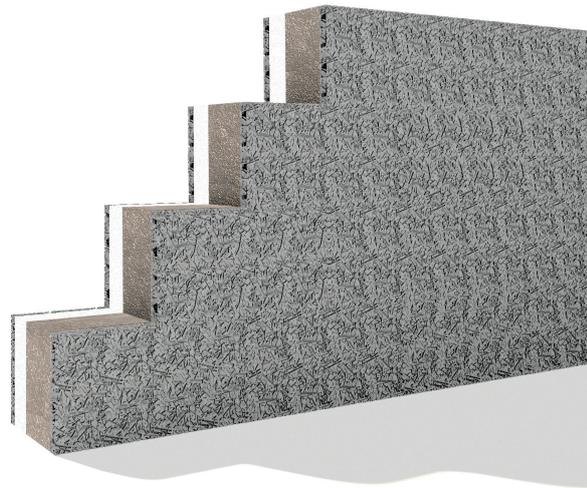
Mantelbetonsteinwand mit Holzleichtbeton-Verguss
